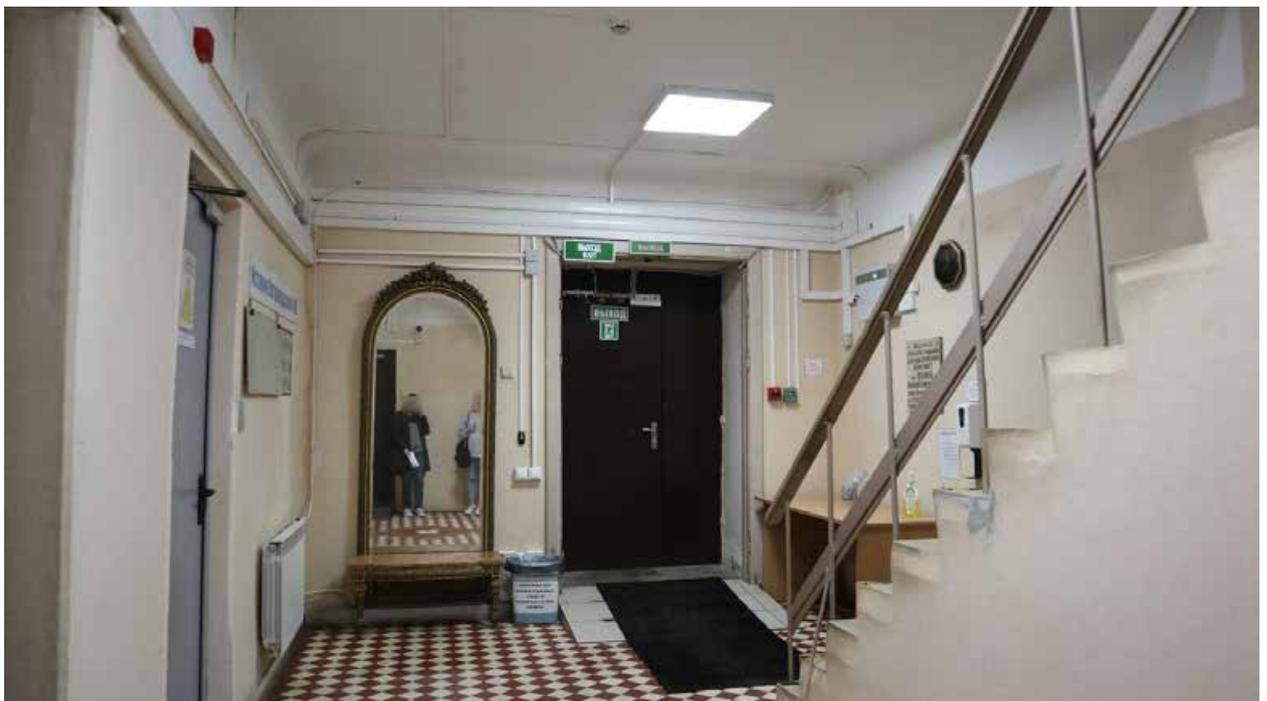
1 этаж, лестница Л4, помещение 2-Н (1).
